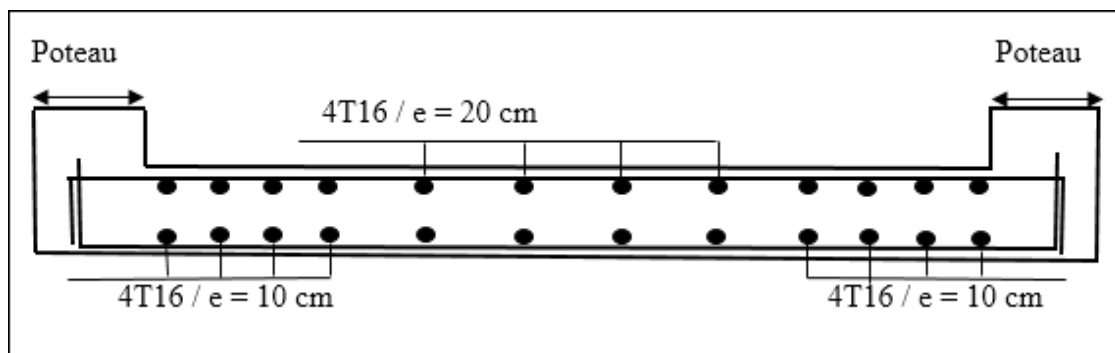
Dispositions du ferrailage longitudinal du voile.
